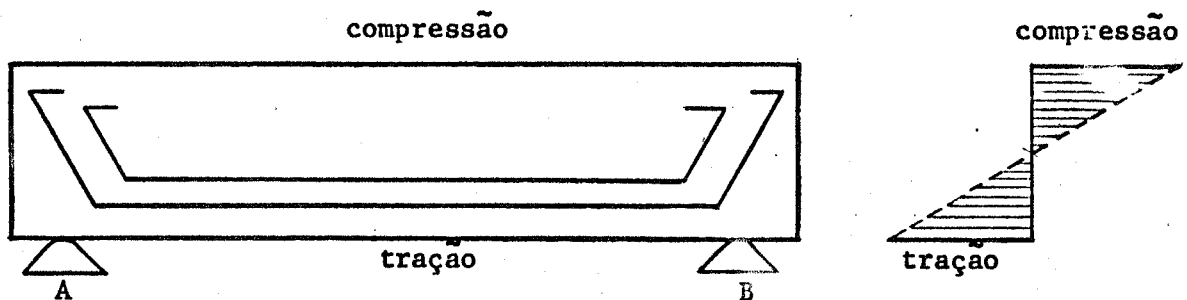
Posição esquemática das ferragens em uma viga de concreto armado e diagrama de tensões.
